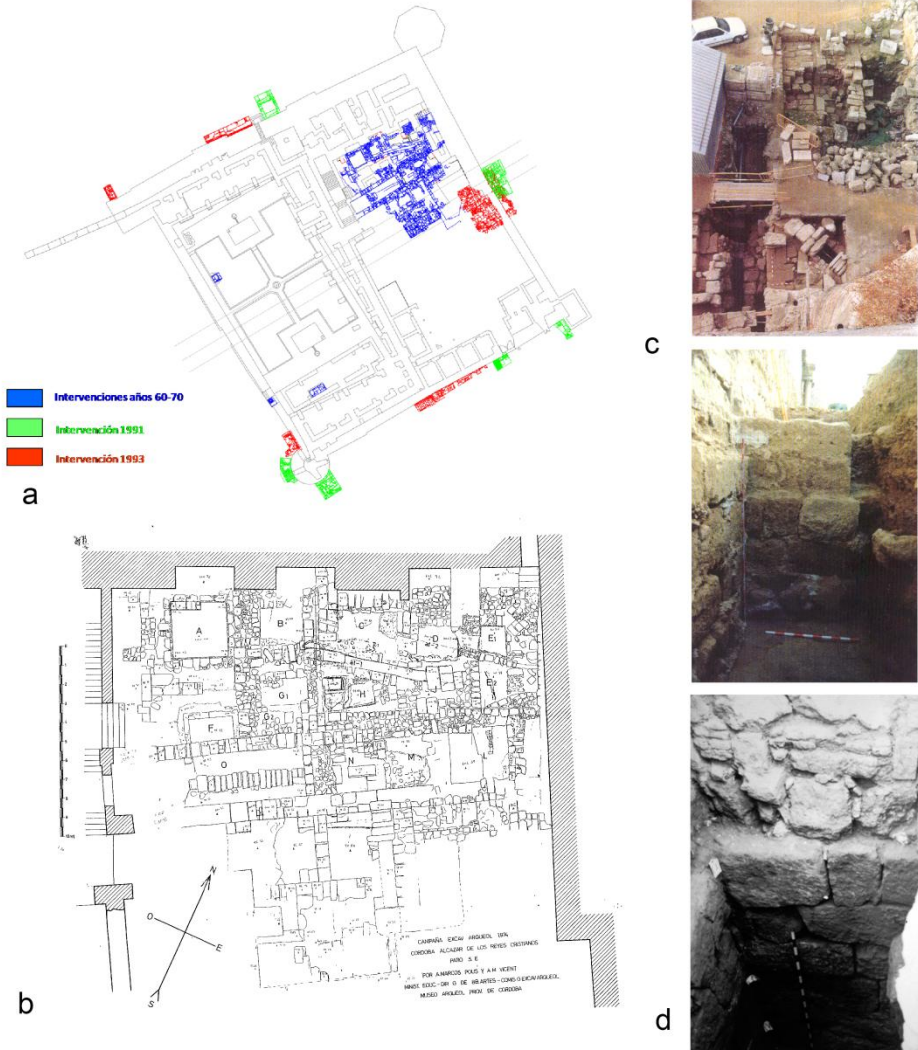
a) Plano de las diferentes áreas excavadas en las intervenciones previas a la Actividad Arqueológica Preventiva de 2002; b) Planta de las estructuras excavadas por A.M^a Vicent y A. Marcos (1974); c) Vista aérea de las estructuras excavadas en el Corte 9 en la excavación de Montejo y Garriguet (1993) y restos de estructuras excavadas por Escribano, reinterpretadas por A. Montejo y J.A. Garriguet (1995) como parte de la muralla meridional de Córdoba; d) Estructuras documentadas por Rodríguez Neila al pie de la torre de la Paloma (1981)
